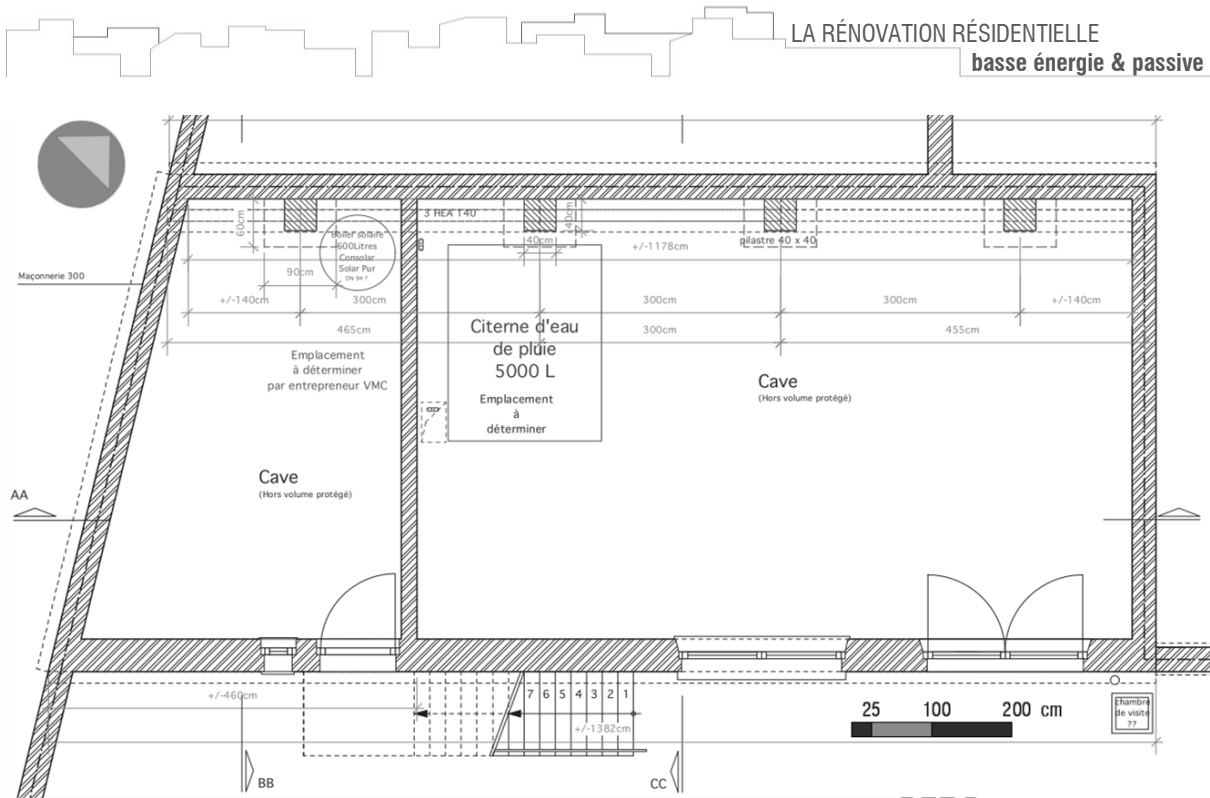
Plan du rez-de-chaussée (Source : Bureau Modelmo, 2010)
